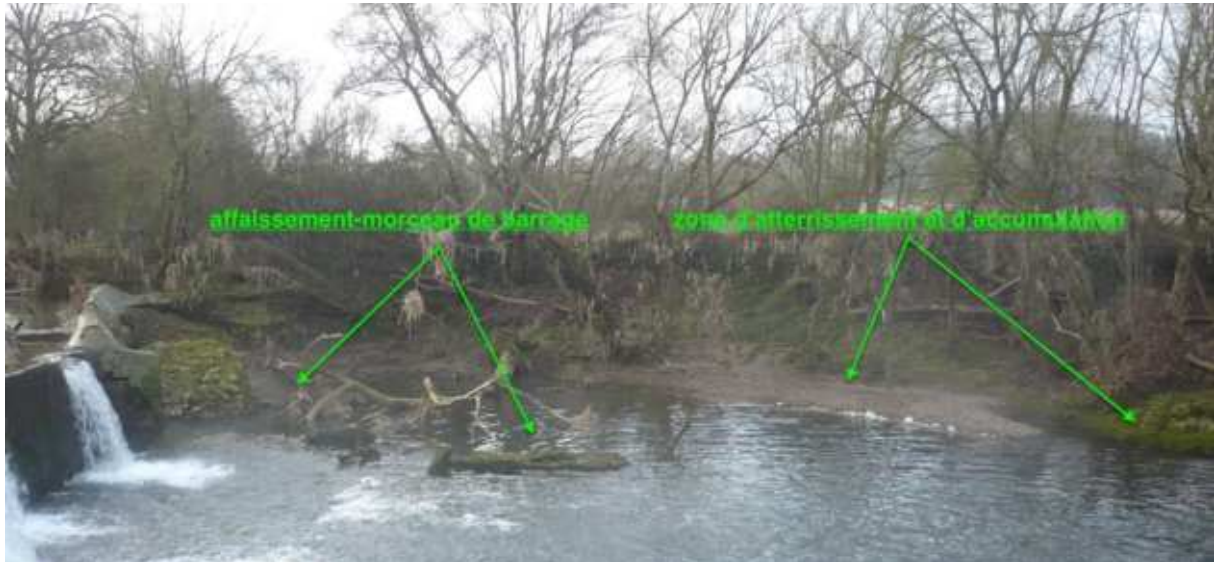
Affaissement du barrage en rive droite et zone d'accumulation.
